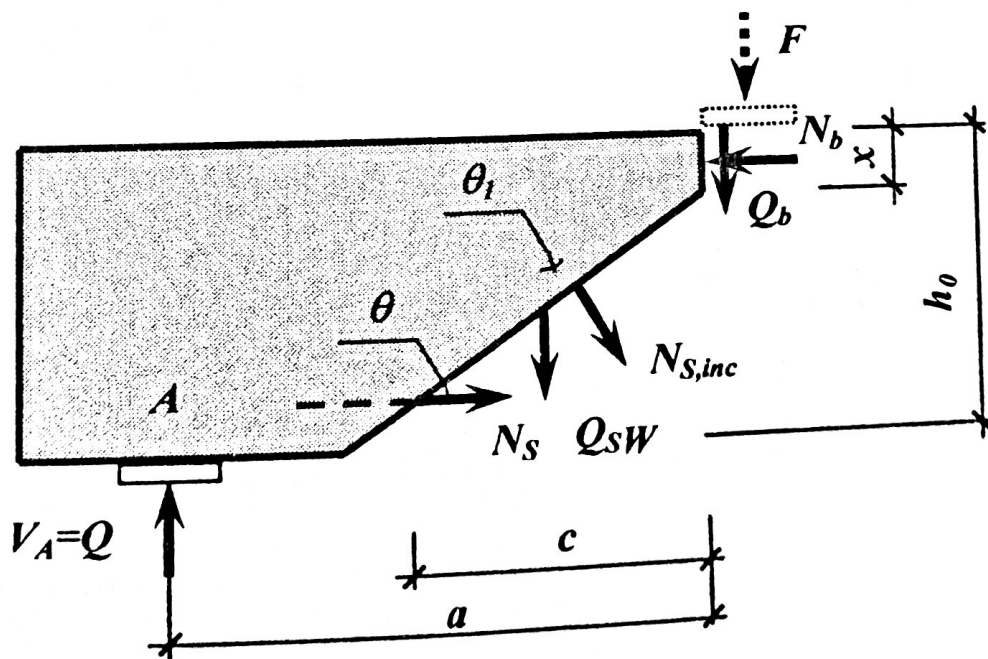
Расчетная схема приопорной части изгибаемого железобетонного элемента, принятая в методе предельного равновесия.
